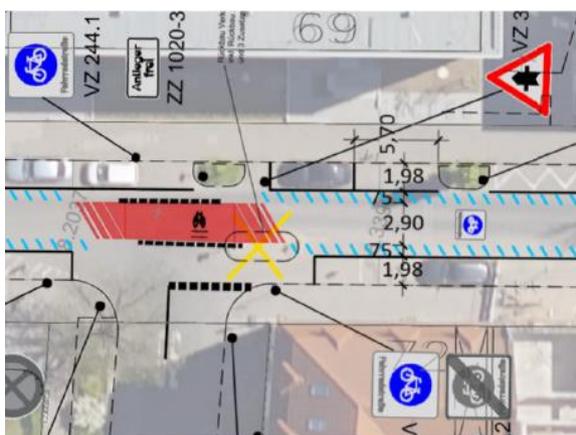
Lageplan Fahrradstraße in Offenbach am Main. (Quelle: Eigene Darstellung)
